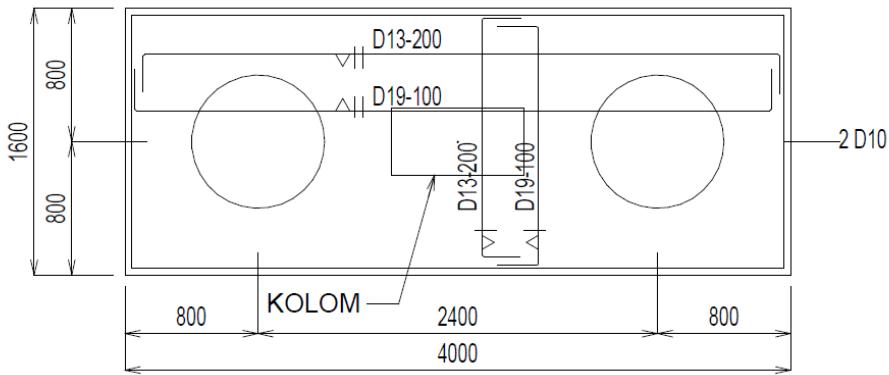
Detail BP-3 Pada Tumpuan Kolom 1
